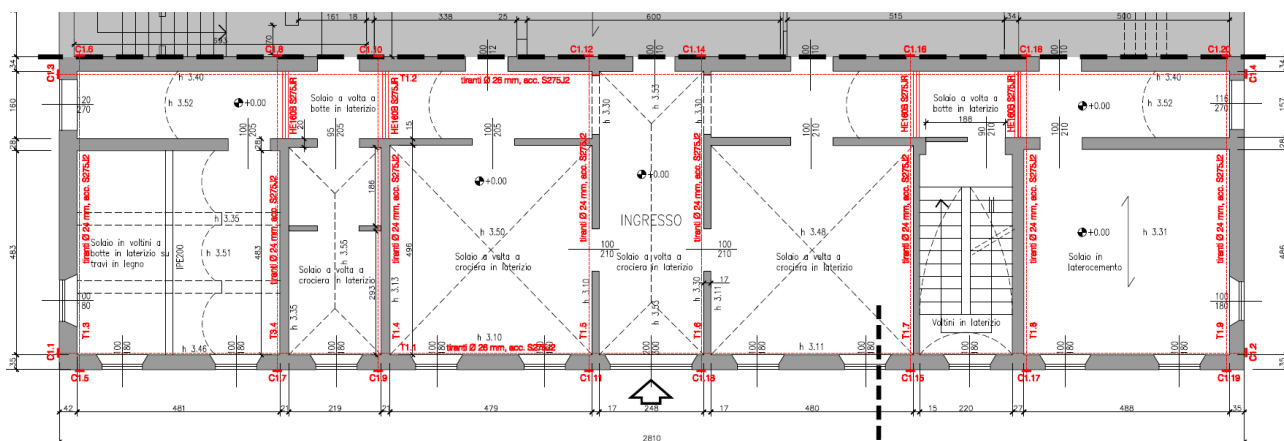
| Pianta piano Terra – Disposizione in pianta di catene
